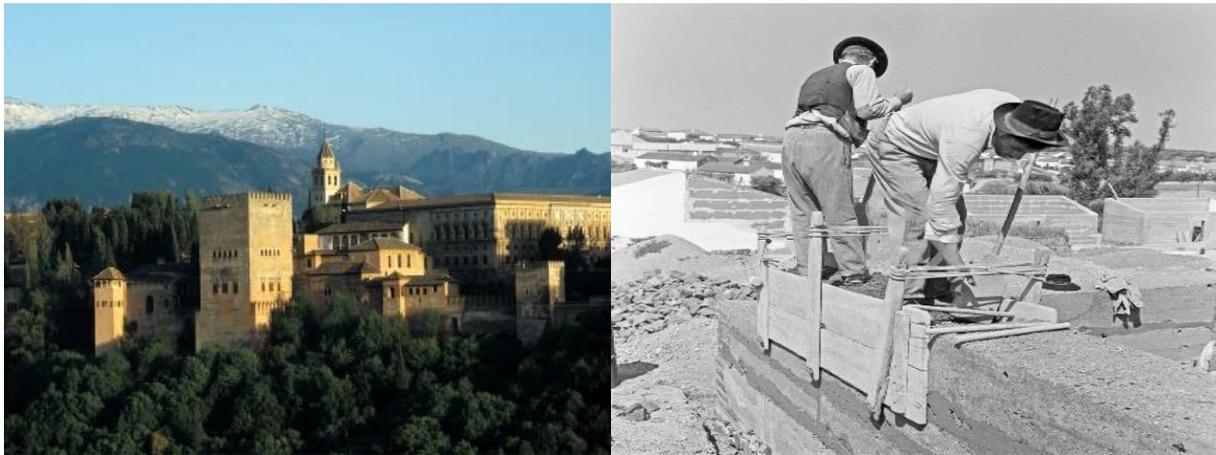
L'Alhambra, « la rouge », de Grenade a été partiellement construite en pisé, au XV^e siècle (Source : CRAterre)/Construction d'un mur en pisé à l'aide de banches en bois, Alfundão, 1955 (Source : OAPIX)
